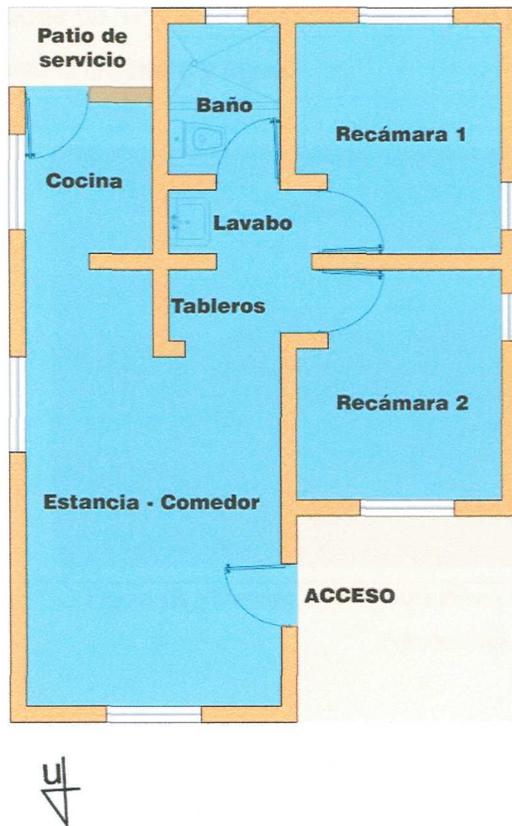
Planta tipo de vivienda en Doctor Arroyo.
